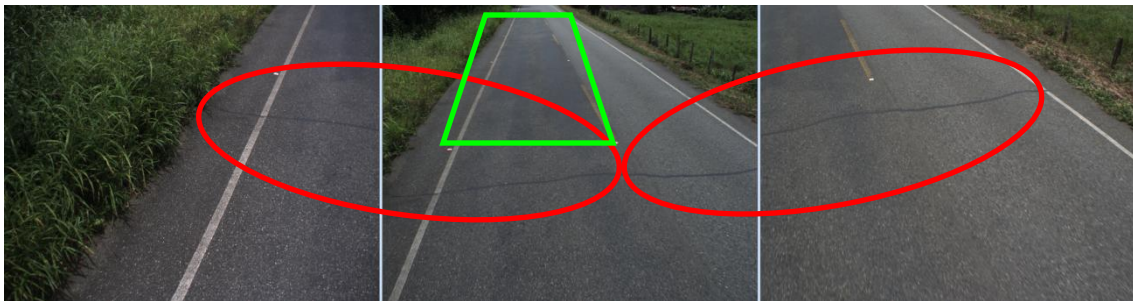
Grietas transversales y exudación, est. 55+200
